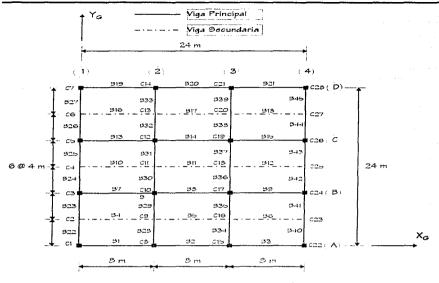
Planta tipo de la estructura con uticación de vigas y columnas
